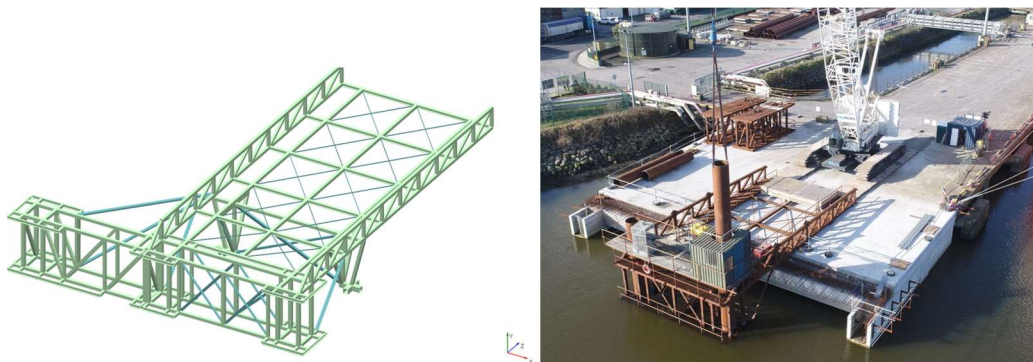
Modelo estrutural da estrutura metálica temporária para cravação de estacas e respetiva instalação da parede combi-wall
